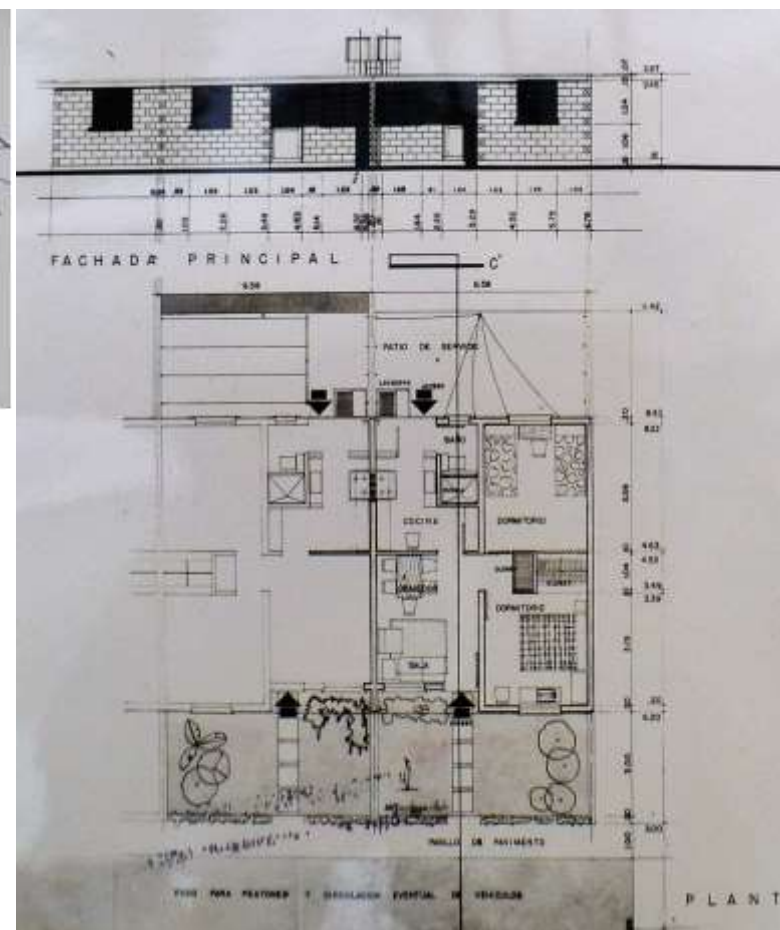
Barrio Quiroga, planta vivienda Tipo de 1 piso pareada con cubierta plana.
